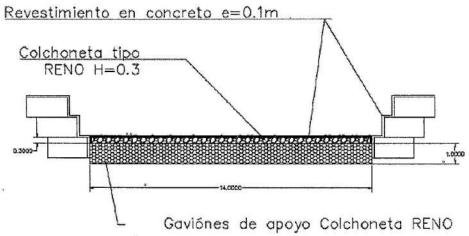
Detalle en perfil de gaviones en márgenes y fondo de cauce en cruce de tubería de sistema GALÁN – AYACUCHO 8" en PK 99+130 a PK 99+370. Fuente: CENIT, 2024.
